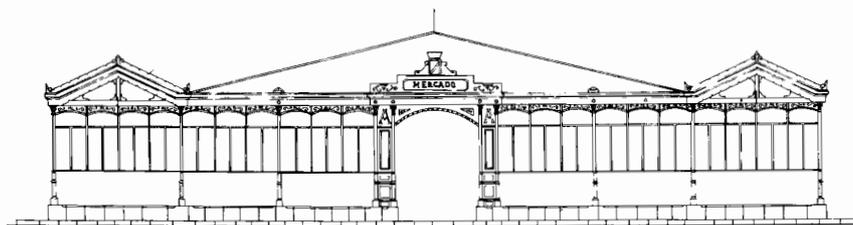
Proyecto de mercado de Javier Aguirre Iturralde. Firmado en enero de 1882. Fachada (según E. Toral).
